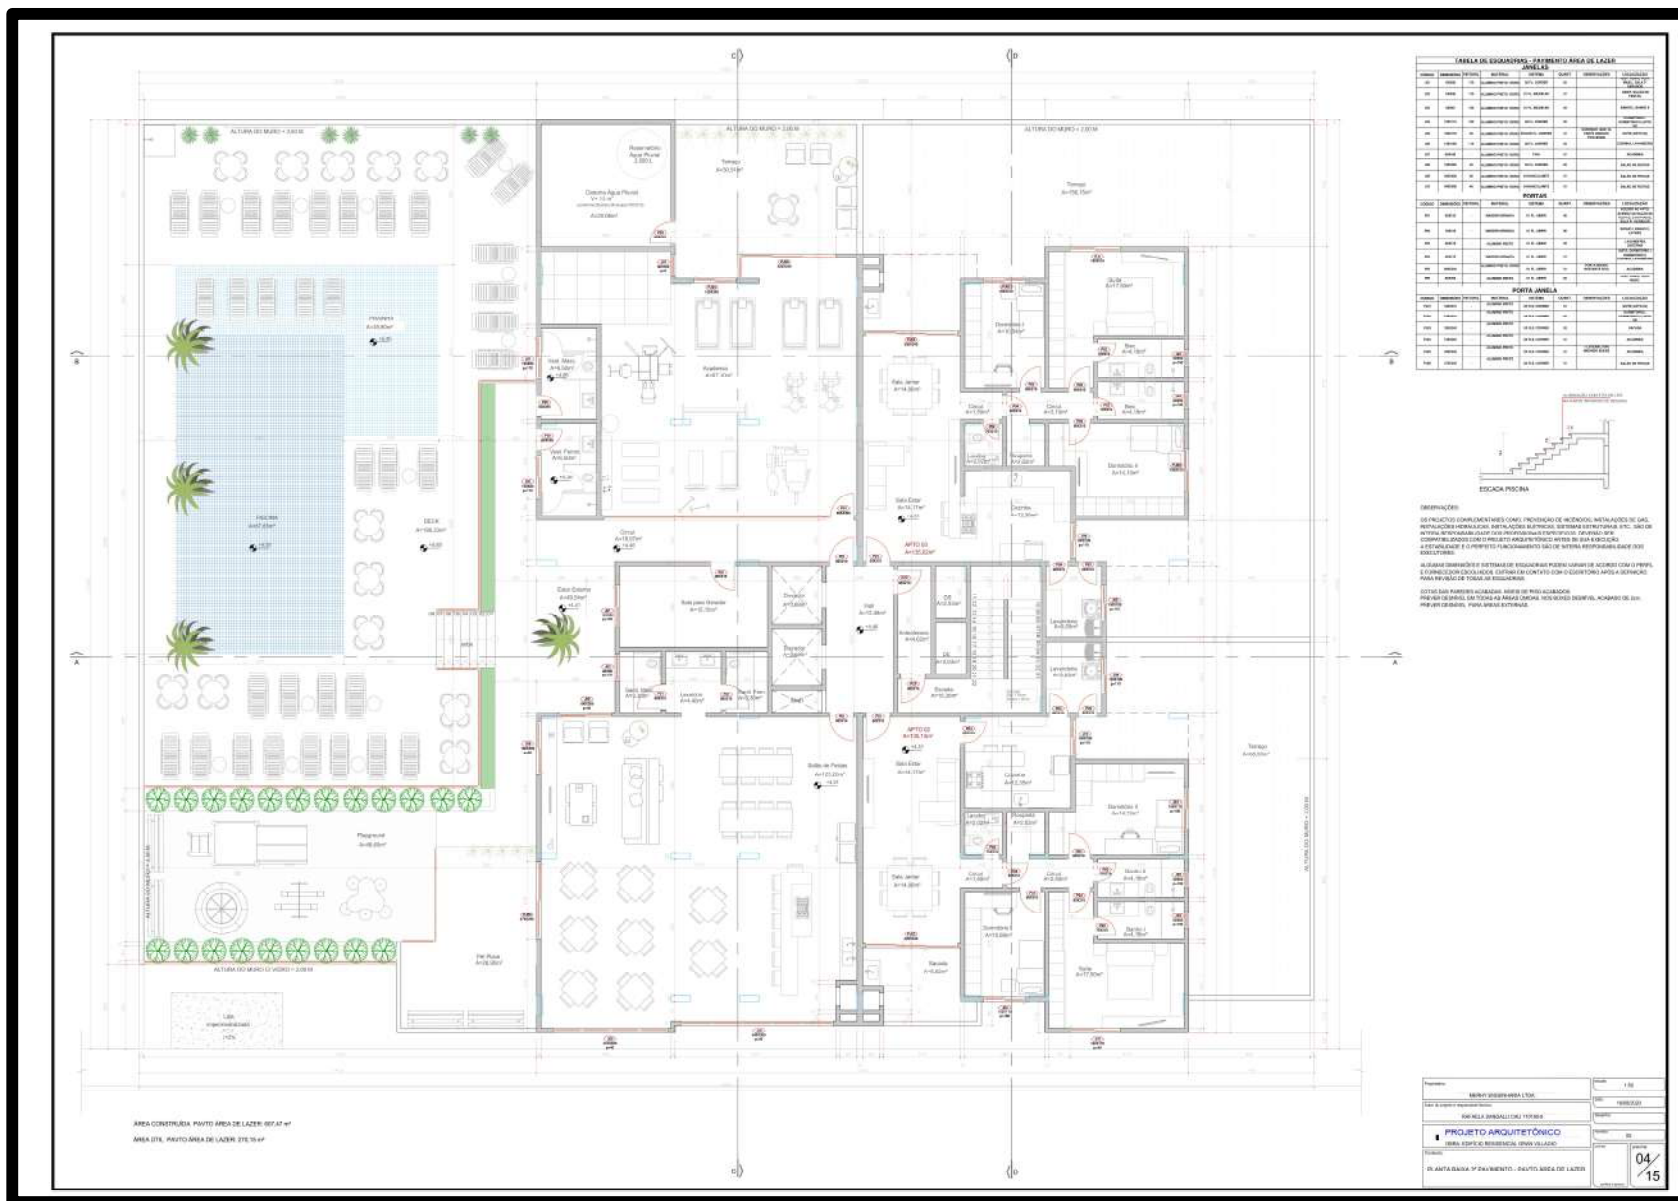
Planta pavimento lazer. Fonte: Construtora Merhy (2020).
